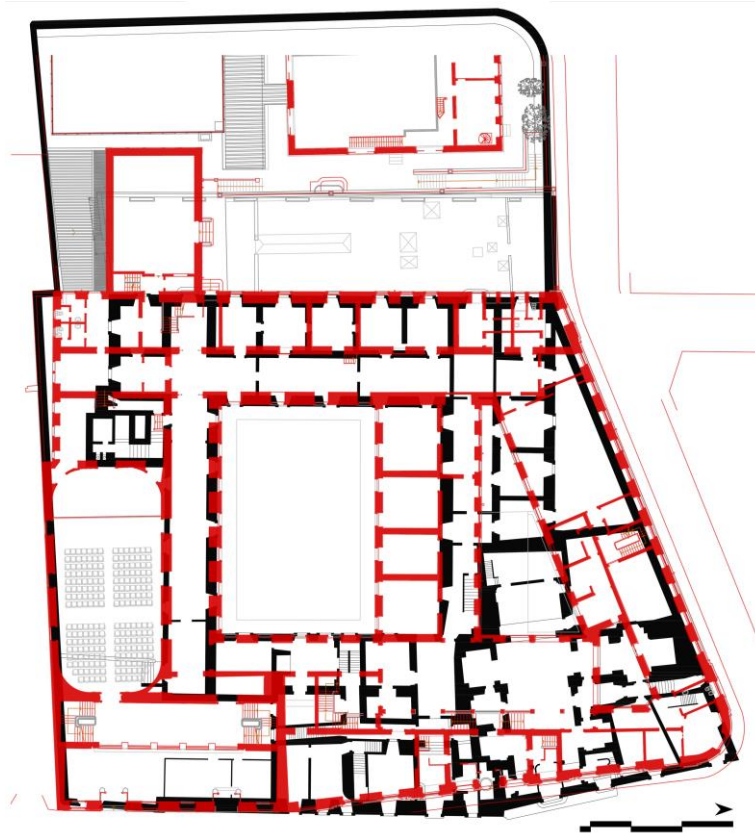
Sobreposição da planta do Convento dos Caetanos em 1748 (a preto) e da planta do novo edifício, em 2017 (a vermelho).
